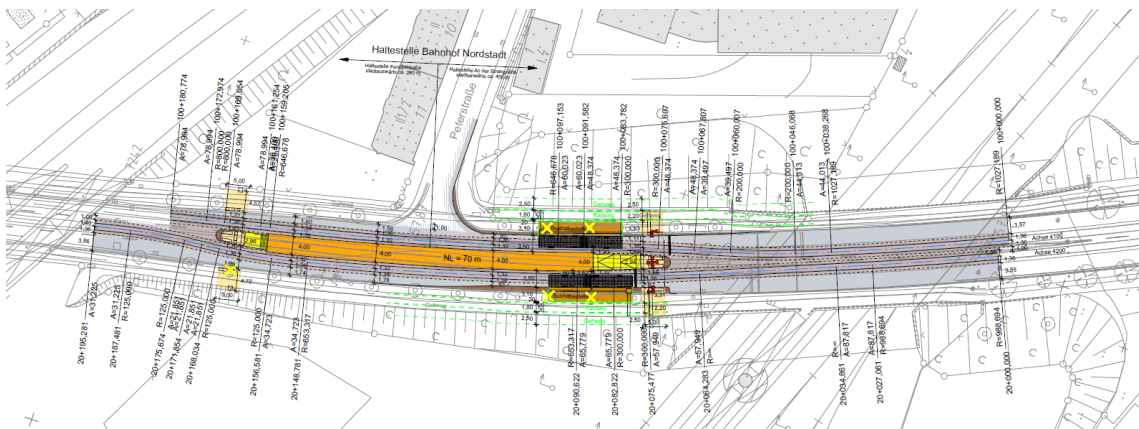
Ausschnitt aus dem Lageplan Variante 4
